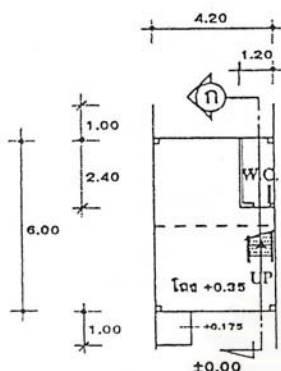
บ้านเรือนแถวชั้นเดียว
